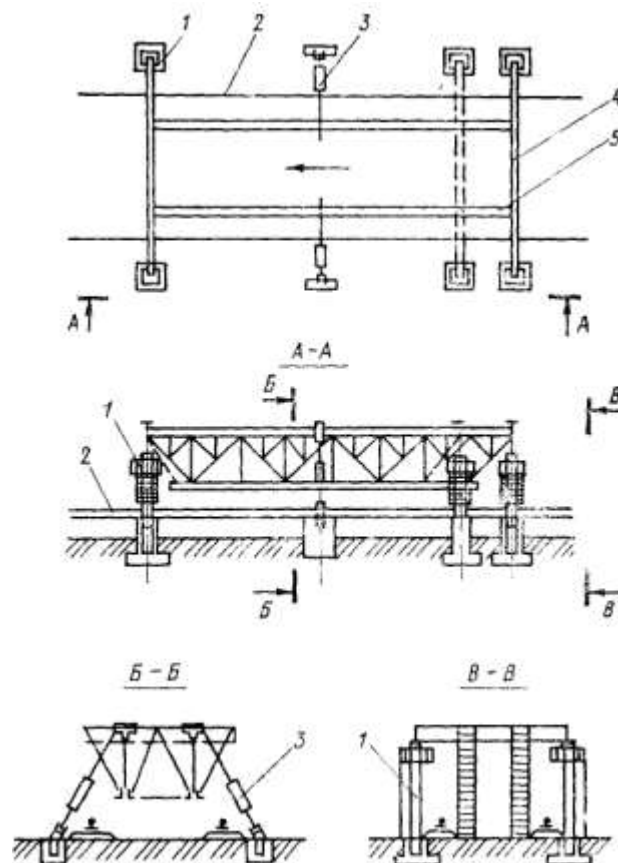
Стенд для сборки подстропильных блоков и стропильных ферм ад конвейерной линии при монтаже покрытий промышленных зданий
